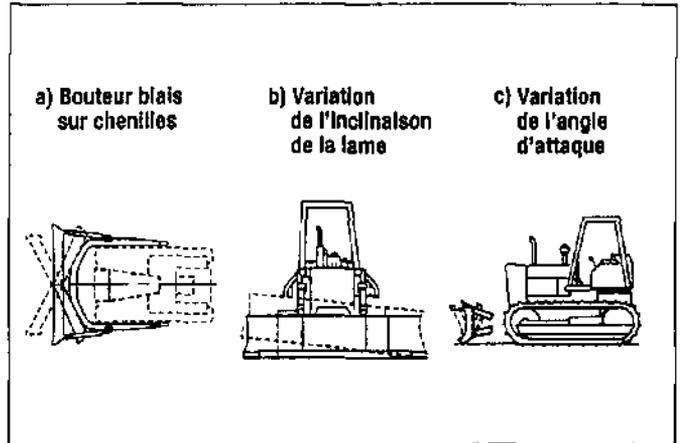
Mouvements et orientations possibles de la lame d'un bouteur.
